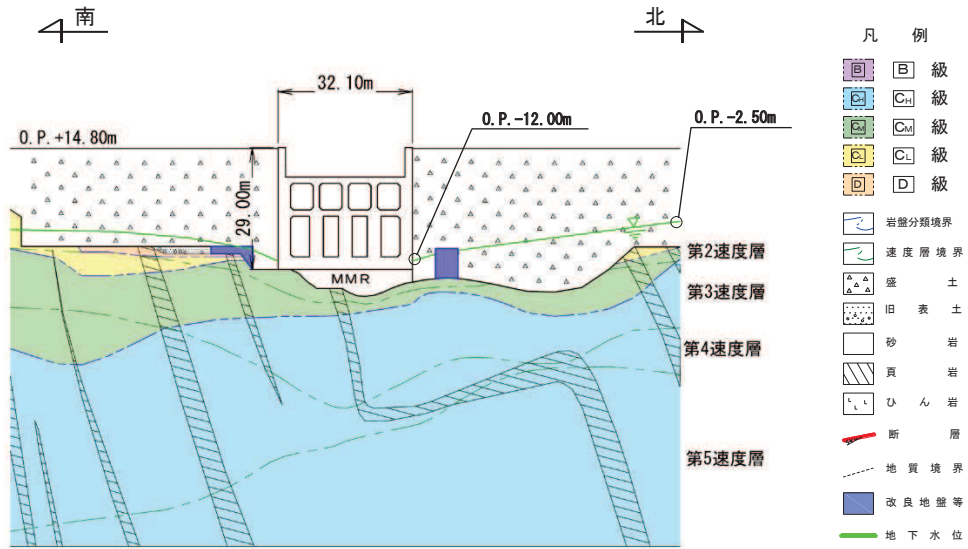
第 3 号機海水ポンプ室 地震時荷重算出用地質断面図
